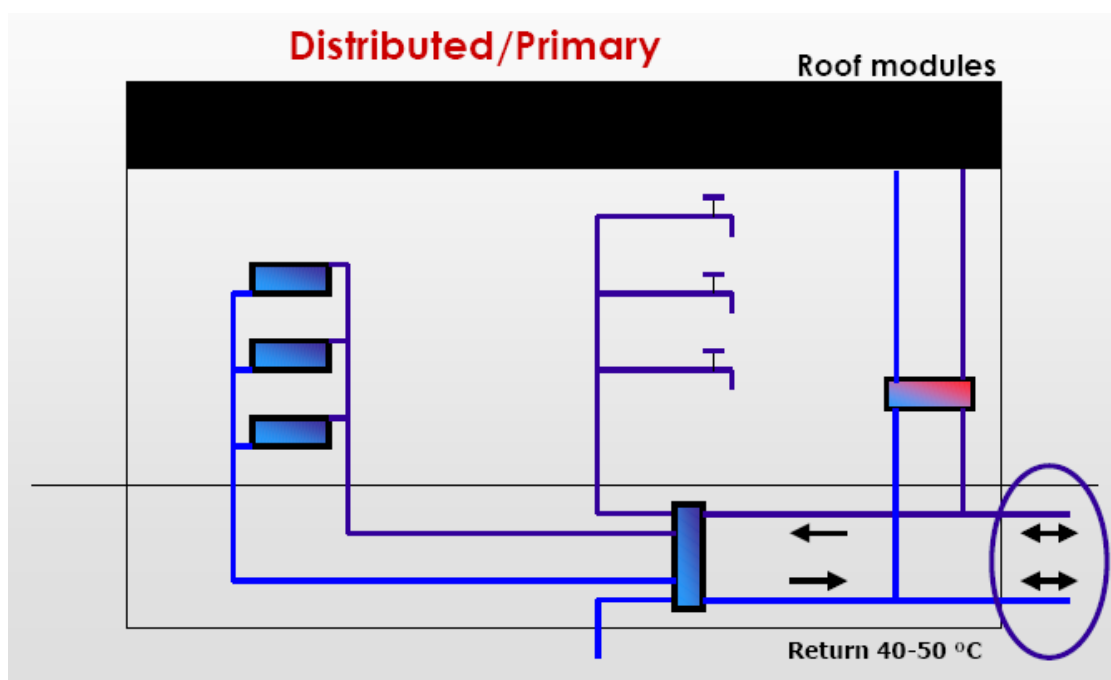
schema zapojení soustavy pro ohřev TUV v rodinném domě
